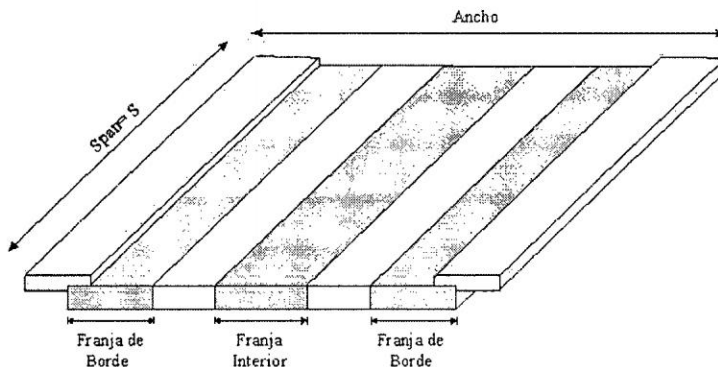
Franjas Distribución de Acero en Losa de Puente.
